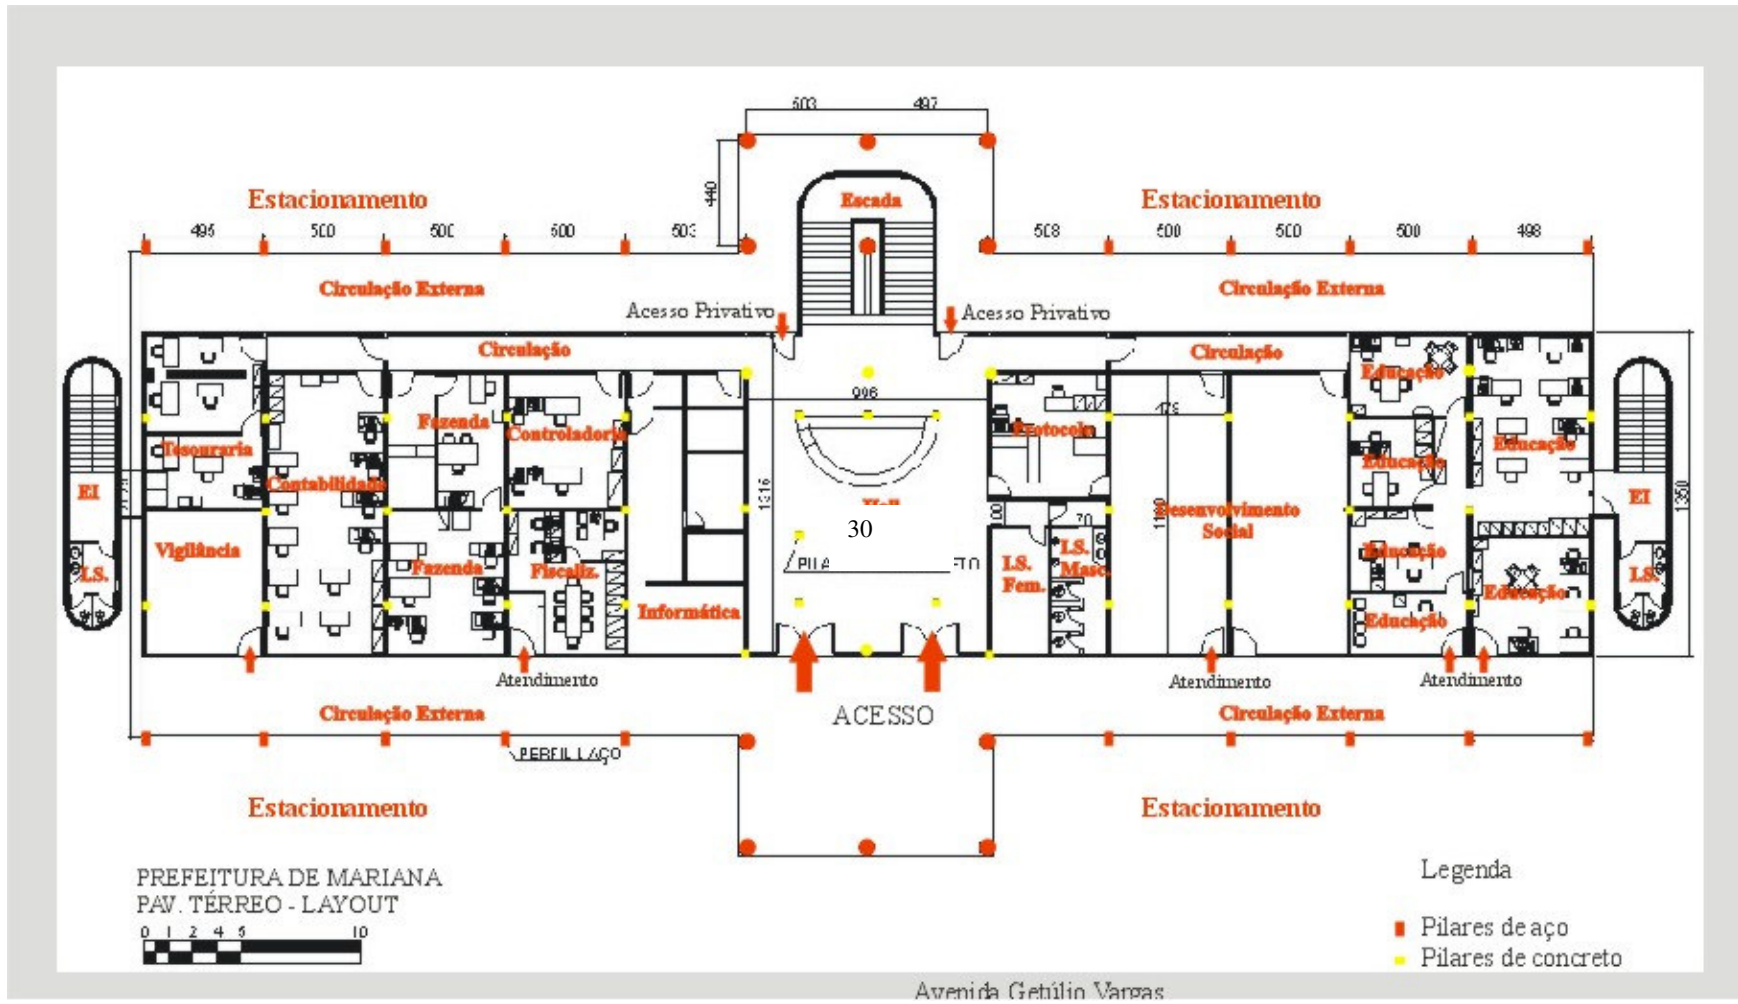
Prefeitura Municipal de Mariana – Pavimento Térreo - Layout.
